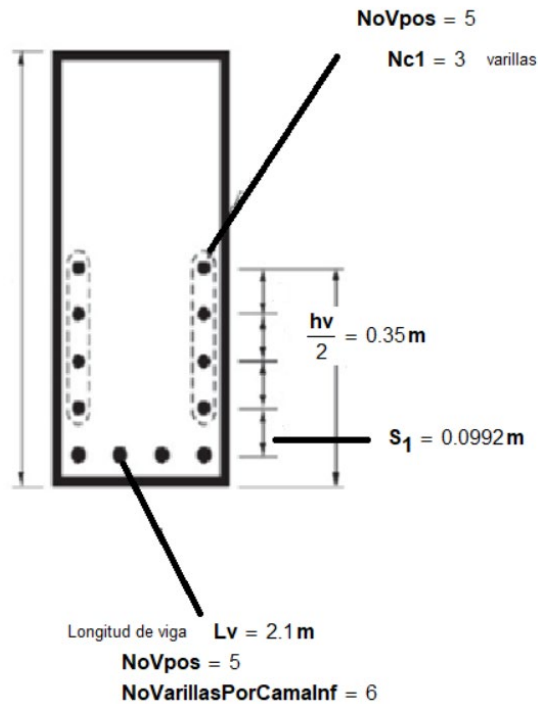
Detalle de refuerzo transversal muro 1 y 2, ejemplar dos
